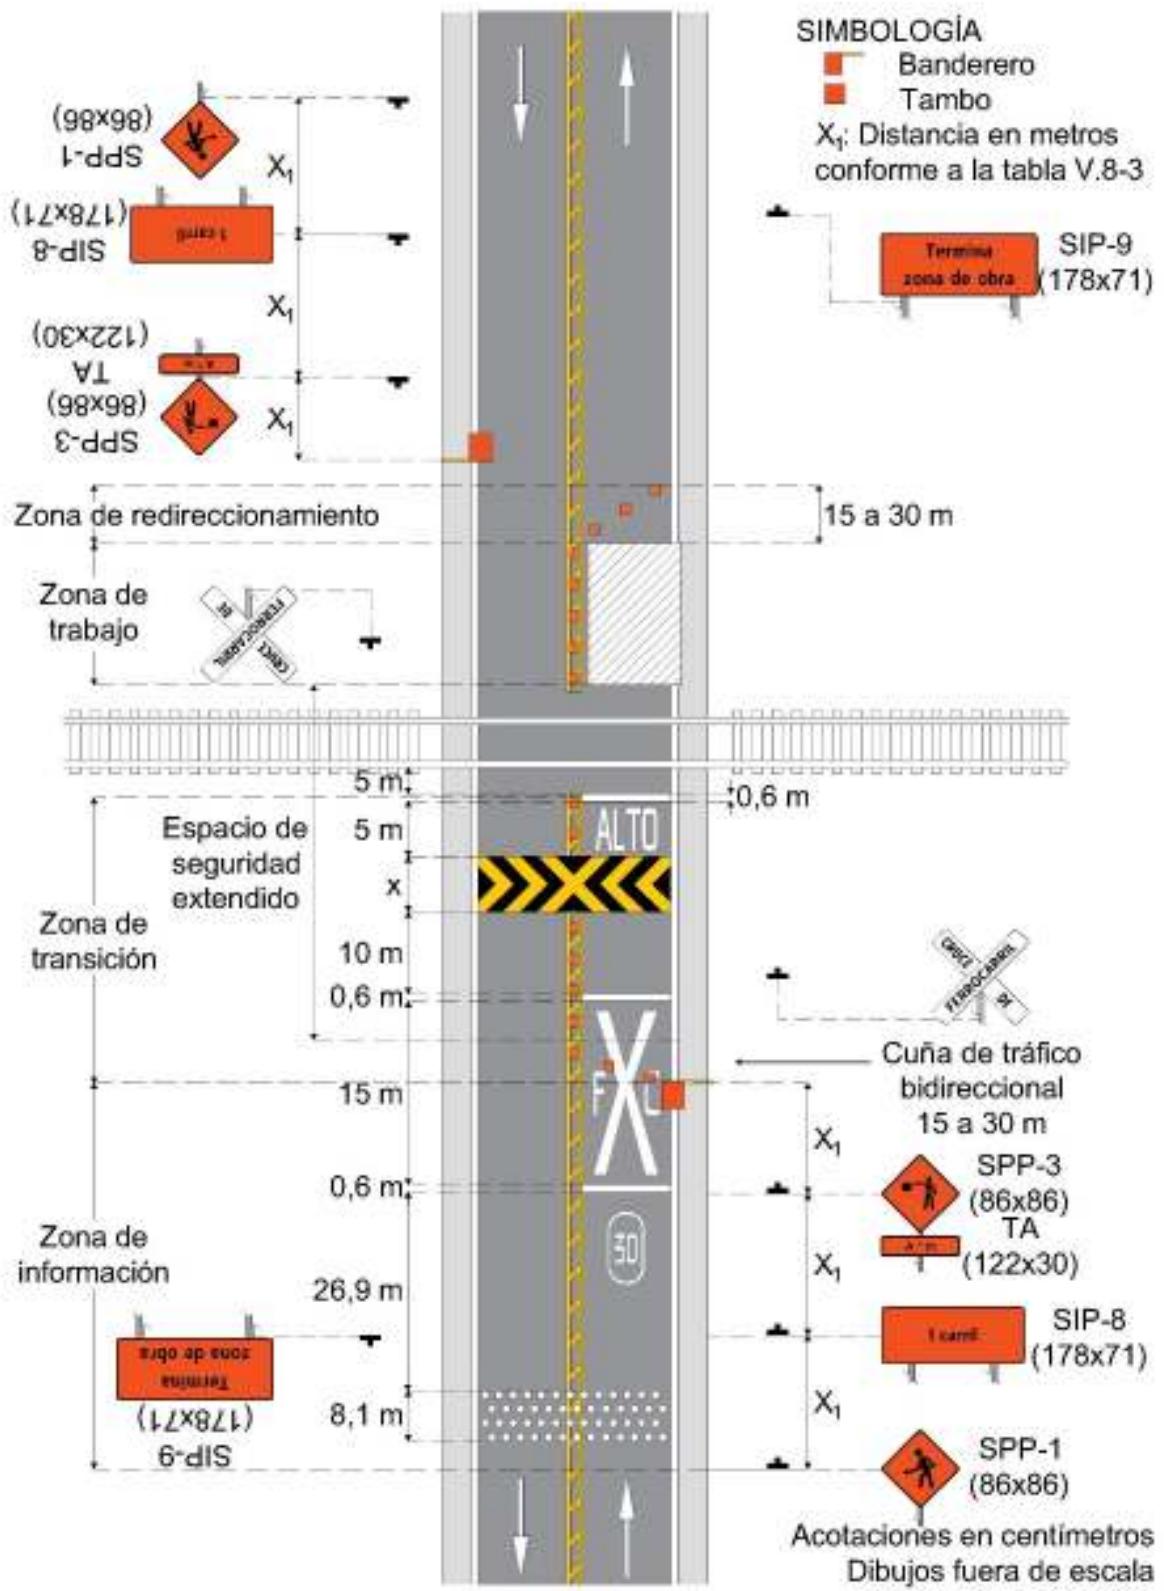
Obras en la cercanía de un cruce ferroviario (Vía con ancho de arroyo vial menor a 9 m)
